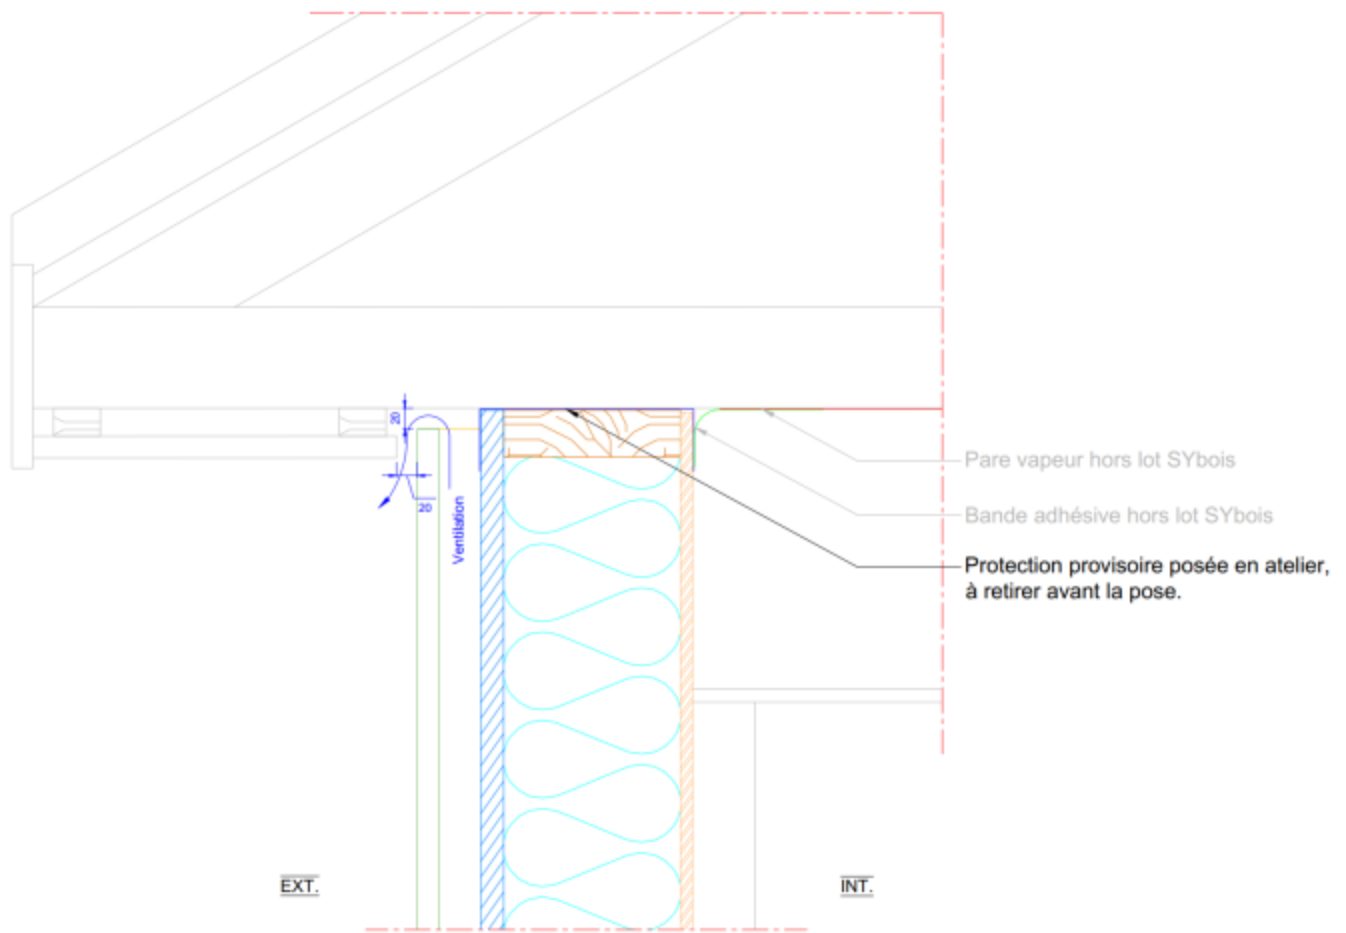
Tête de mur intégrant le procédé SYBOIS MUR – Jonction avec la toiture – Toiture assemblée sur chantier
